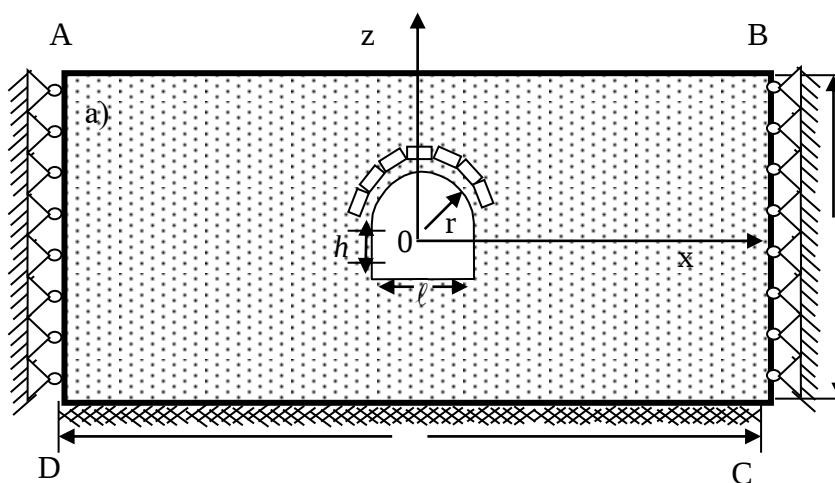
Подземное сооружение заложено в несвязном грунте с укреплениями сводовой части.
